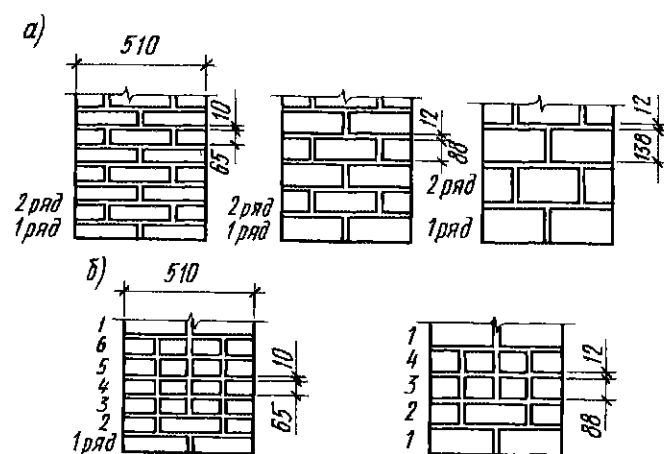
Схемы перевязки кладки стен толщиной в два кирпича.
